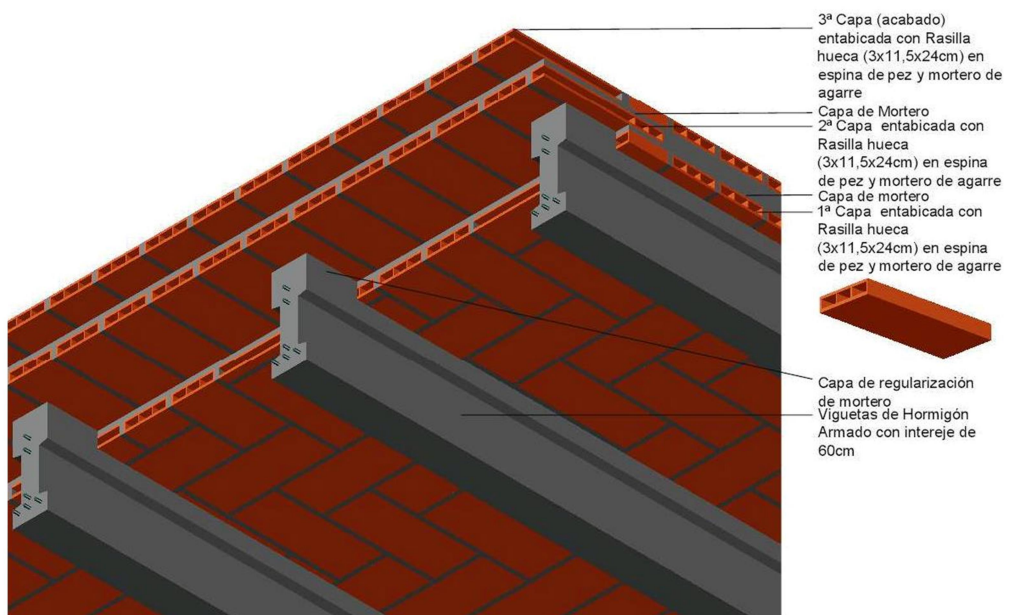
Detalle de forjado entabicado de tres capas de rasilla hueca con viguetas prefabricadas de hormigón armado
